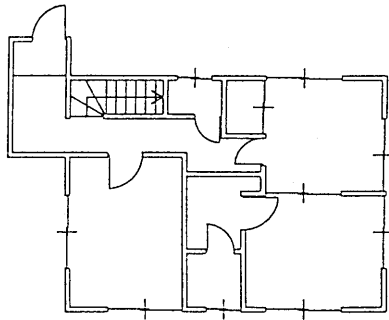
解析対象建築物平面図 (No.29, No.30)
